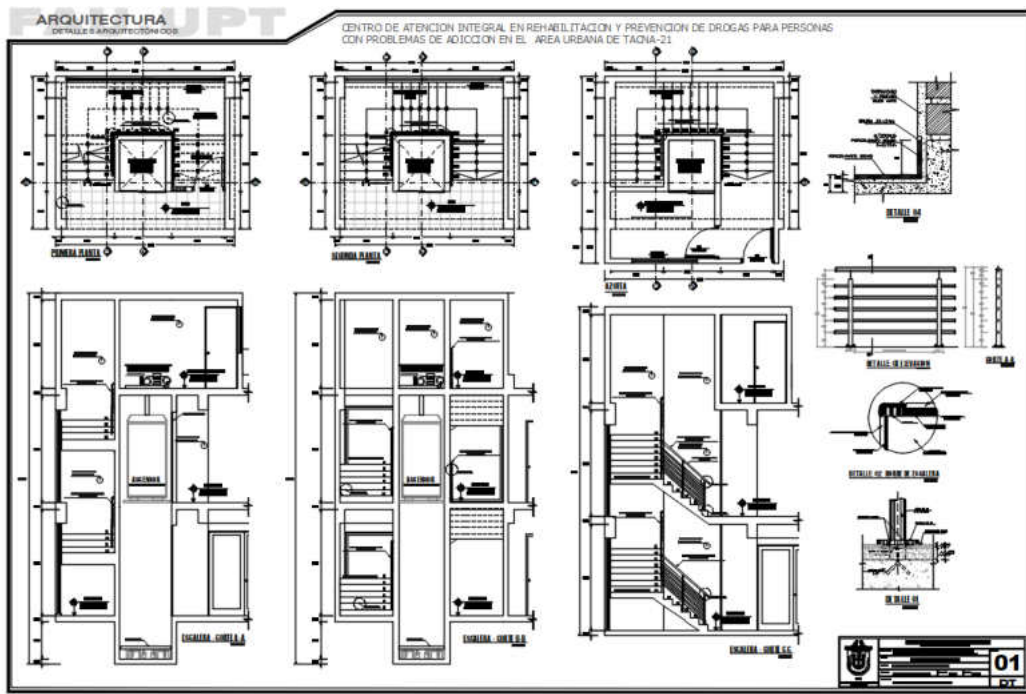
detalles arquitectónicos-escaleras, fuente elaboración propia.
